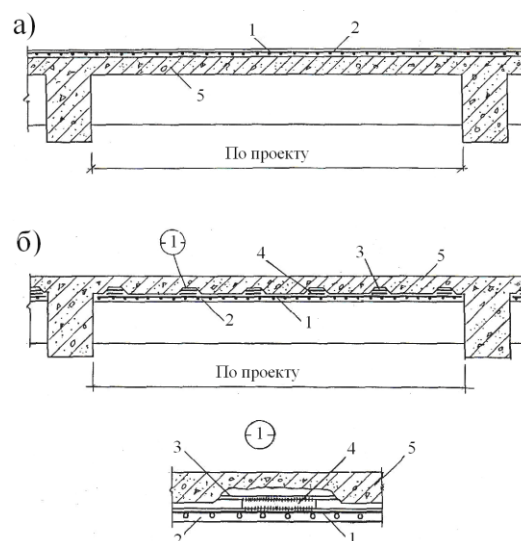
Усиление монолитной плиты перекрытия односторонним наращиванием сверху (а) и снизу (б):
